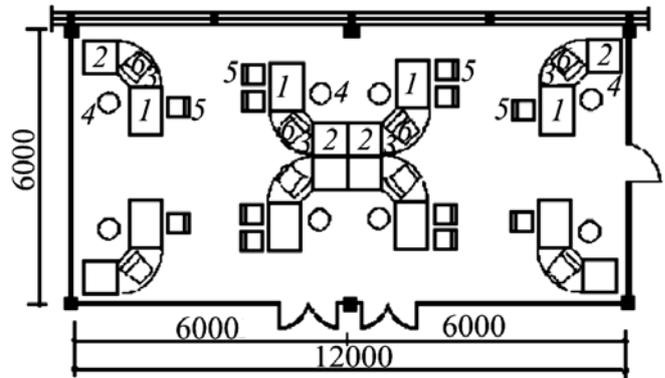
Операционный зал с группами столов операторов: 1 — стол рабочий; 2 — стол компьютерный; 3 — стол-вставка; 4 — стул рабочий подъемно-поворотный; 5 — стул (кресло) для клиентов; 6 — компьютер
